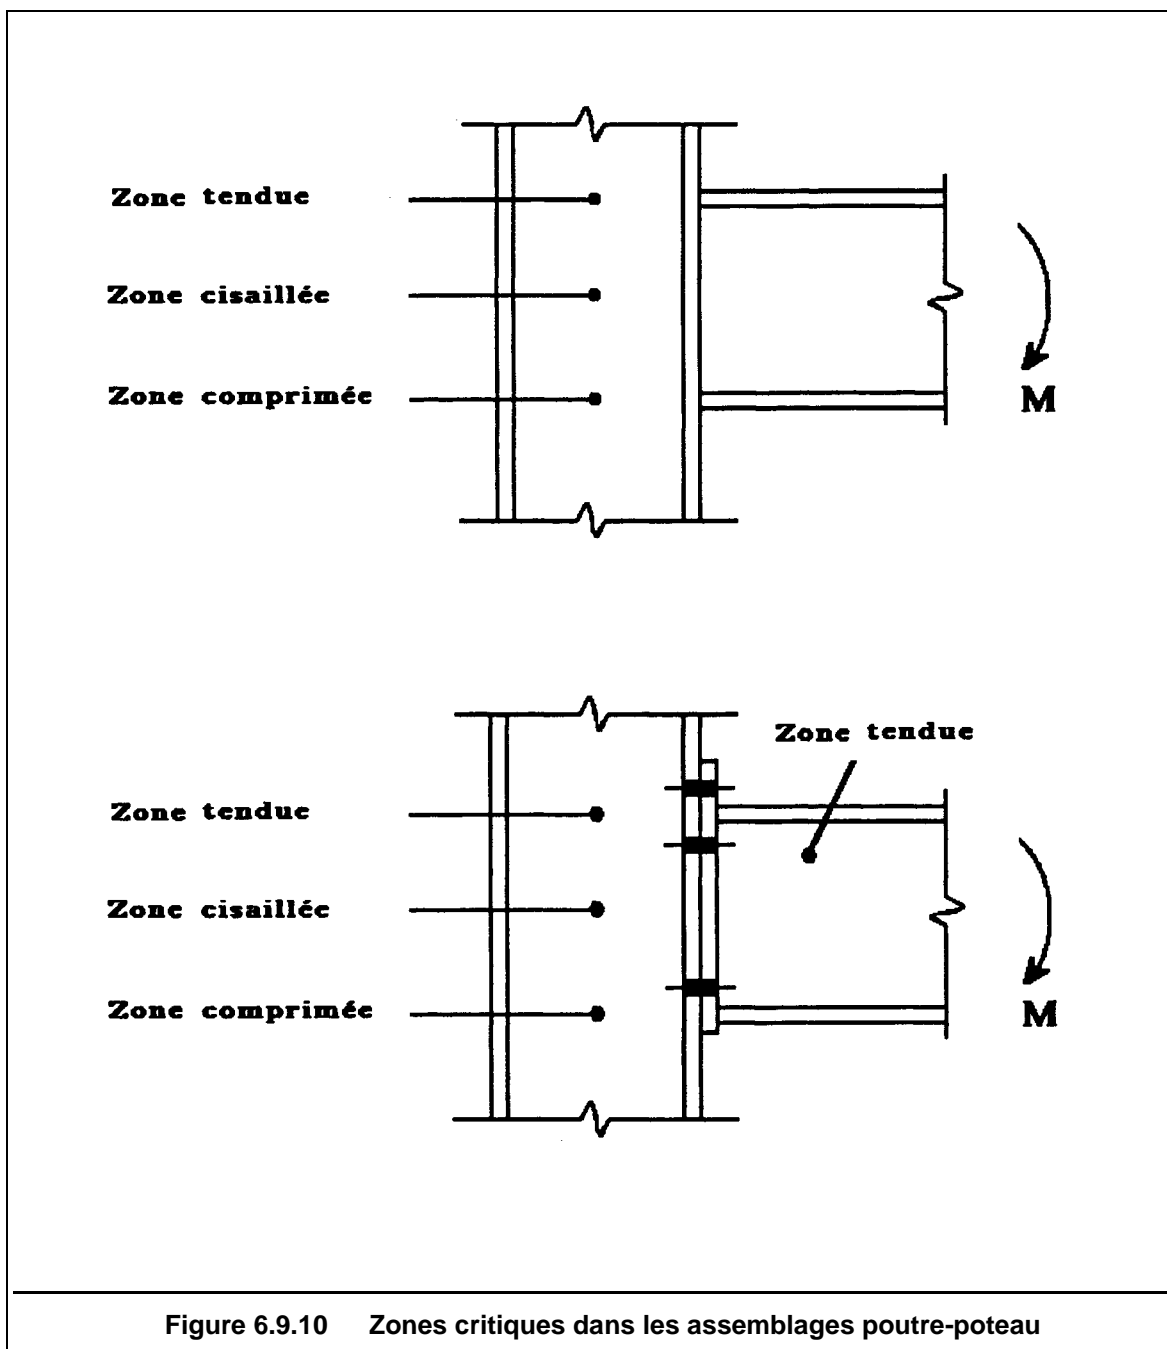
Zones critiques dans les assemblages poutre-poteau
